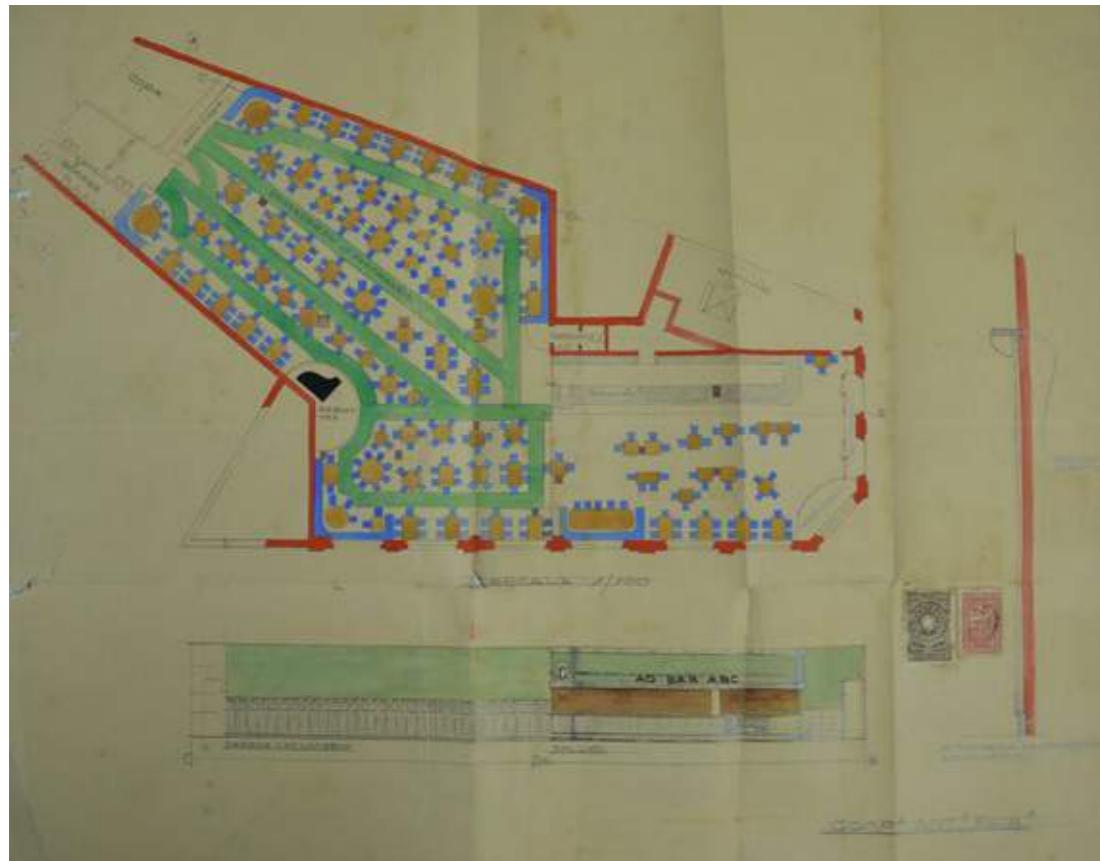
Planta do pavimento térreo, onde seria implantado pela Companhia Antarctica Paulista um restaurante de luxo, outubro de 1935. Fonte: Arquivo Geral do Município de São Paulo.
